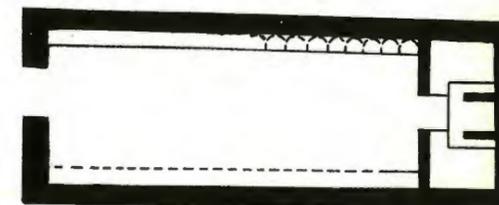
PLAN DE LA CHAPELLE AU NORD-EST DE L'ENCEINTE DU VILLAGE.
